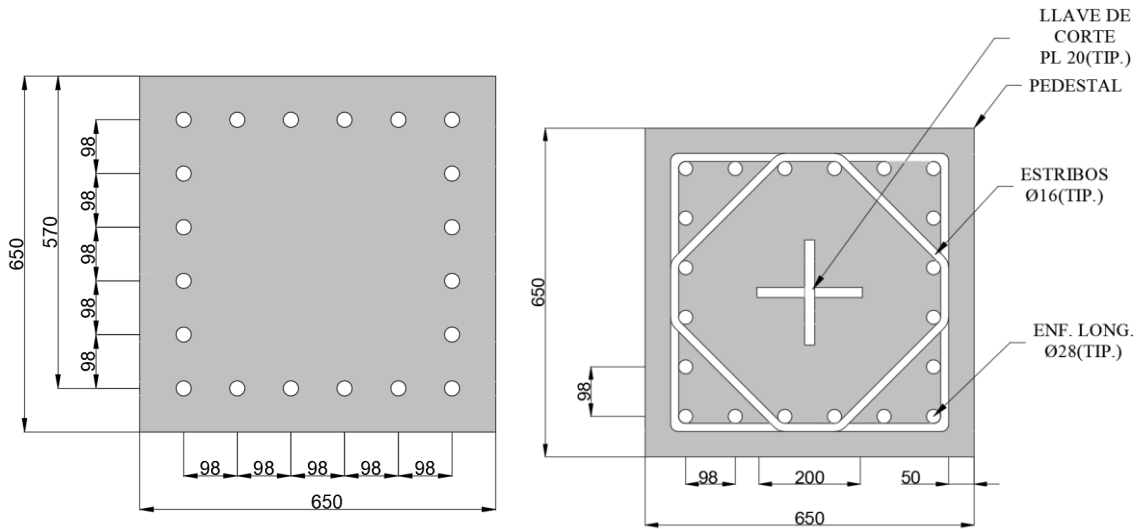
Detalle de la armadura longitudinal y transversal.
